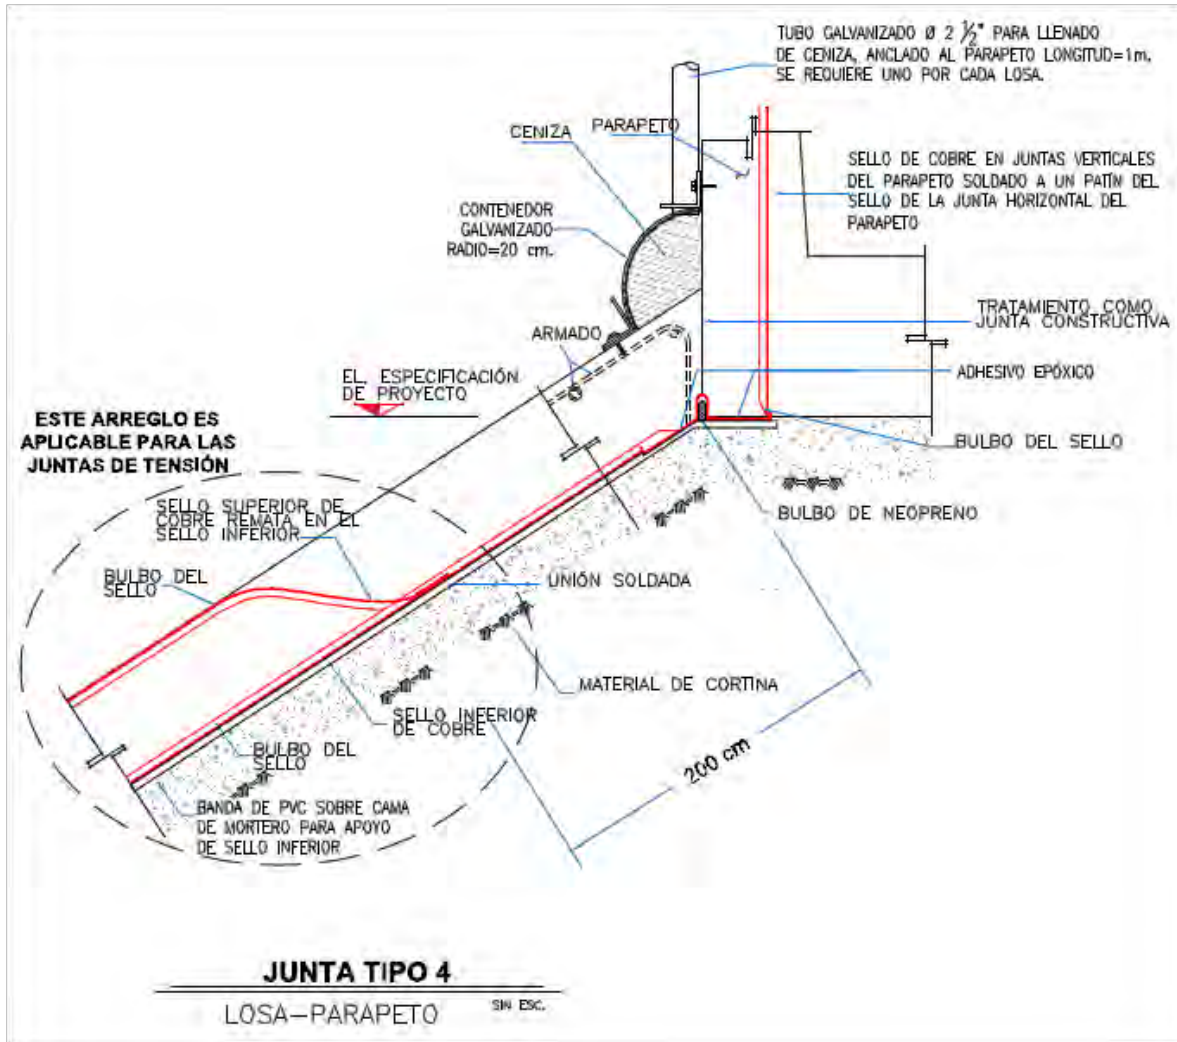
Detalle de la junta de parapeto (Tipo 4).
